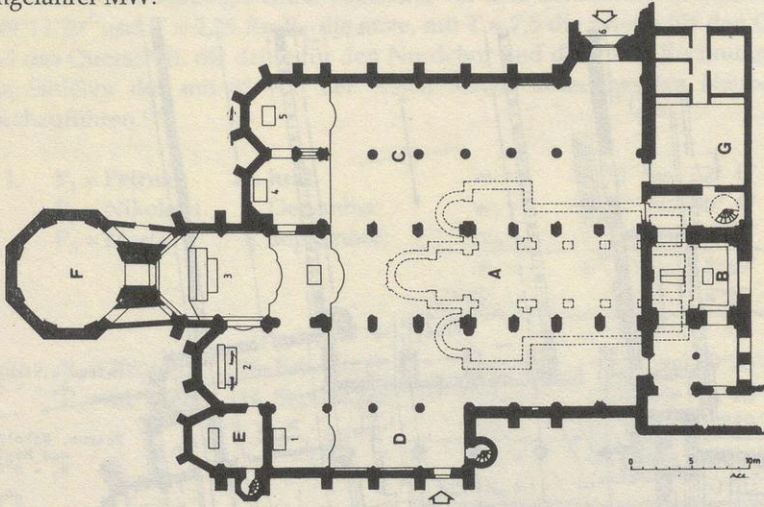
Propstei Pfarrkirche Kornelimünster (Grundriß) (aus dem Kirchenführer des Propsteipfarramtes St. Kornelius – (1987)
